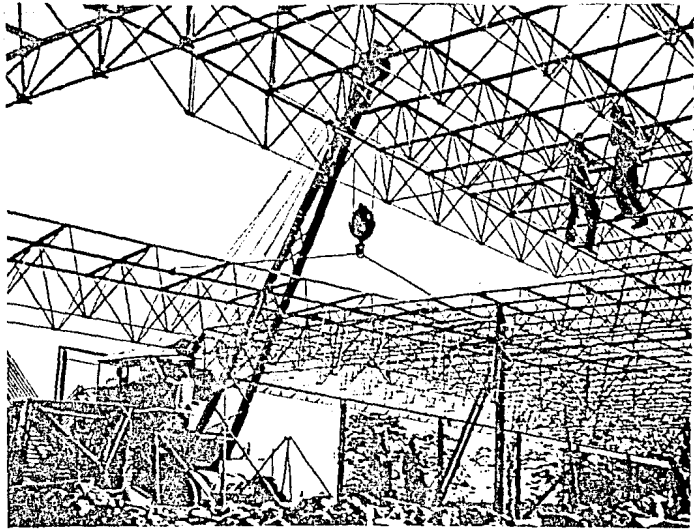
ENTRAMADO ARMADO DEL SISTEMA "SPACE DECK" PARA NA-
